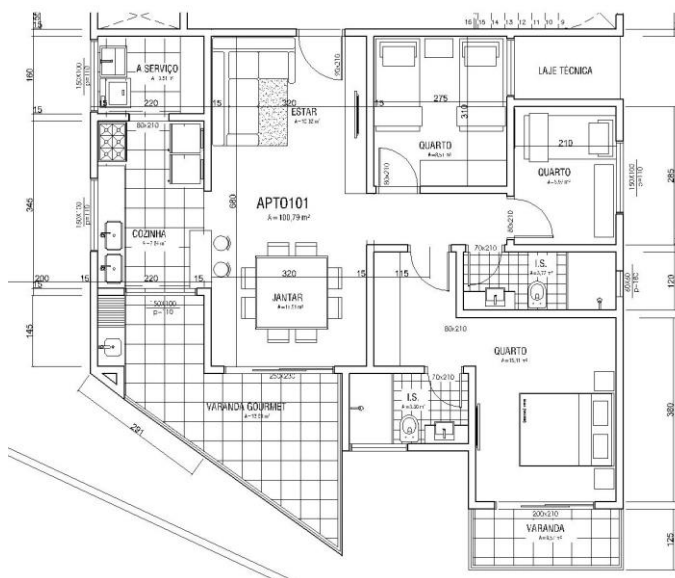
Apartamento tipo 2. Fonte: RDB Construtora.
